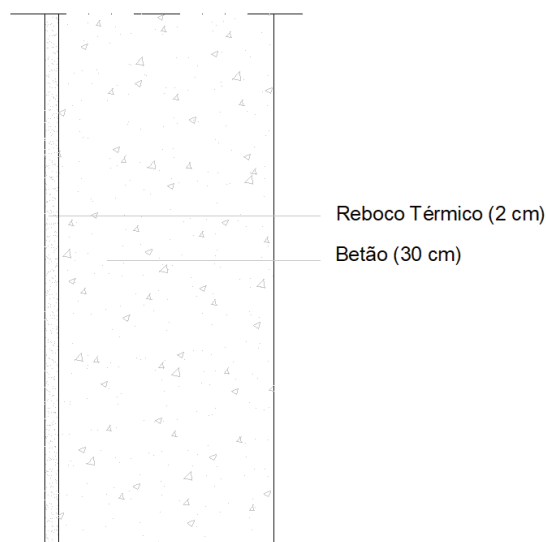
Pormenor construtivo da parede interior tipo X (área técnica AVAC)
